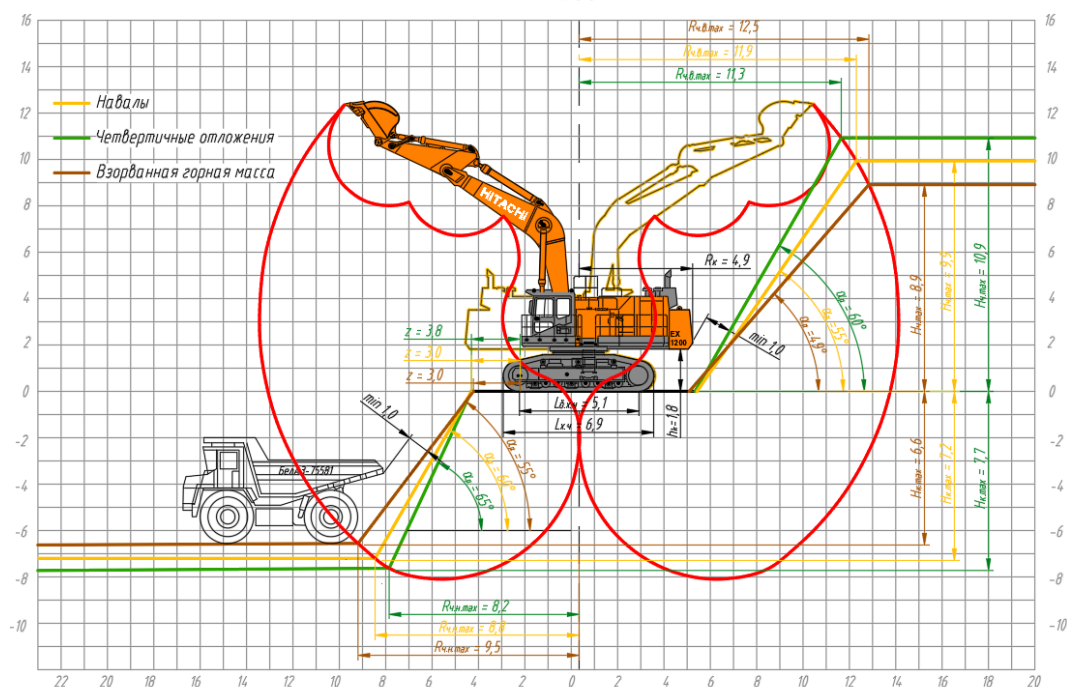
Кинематическая схема движения ковша экскаватора Hitachi EX-1200
